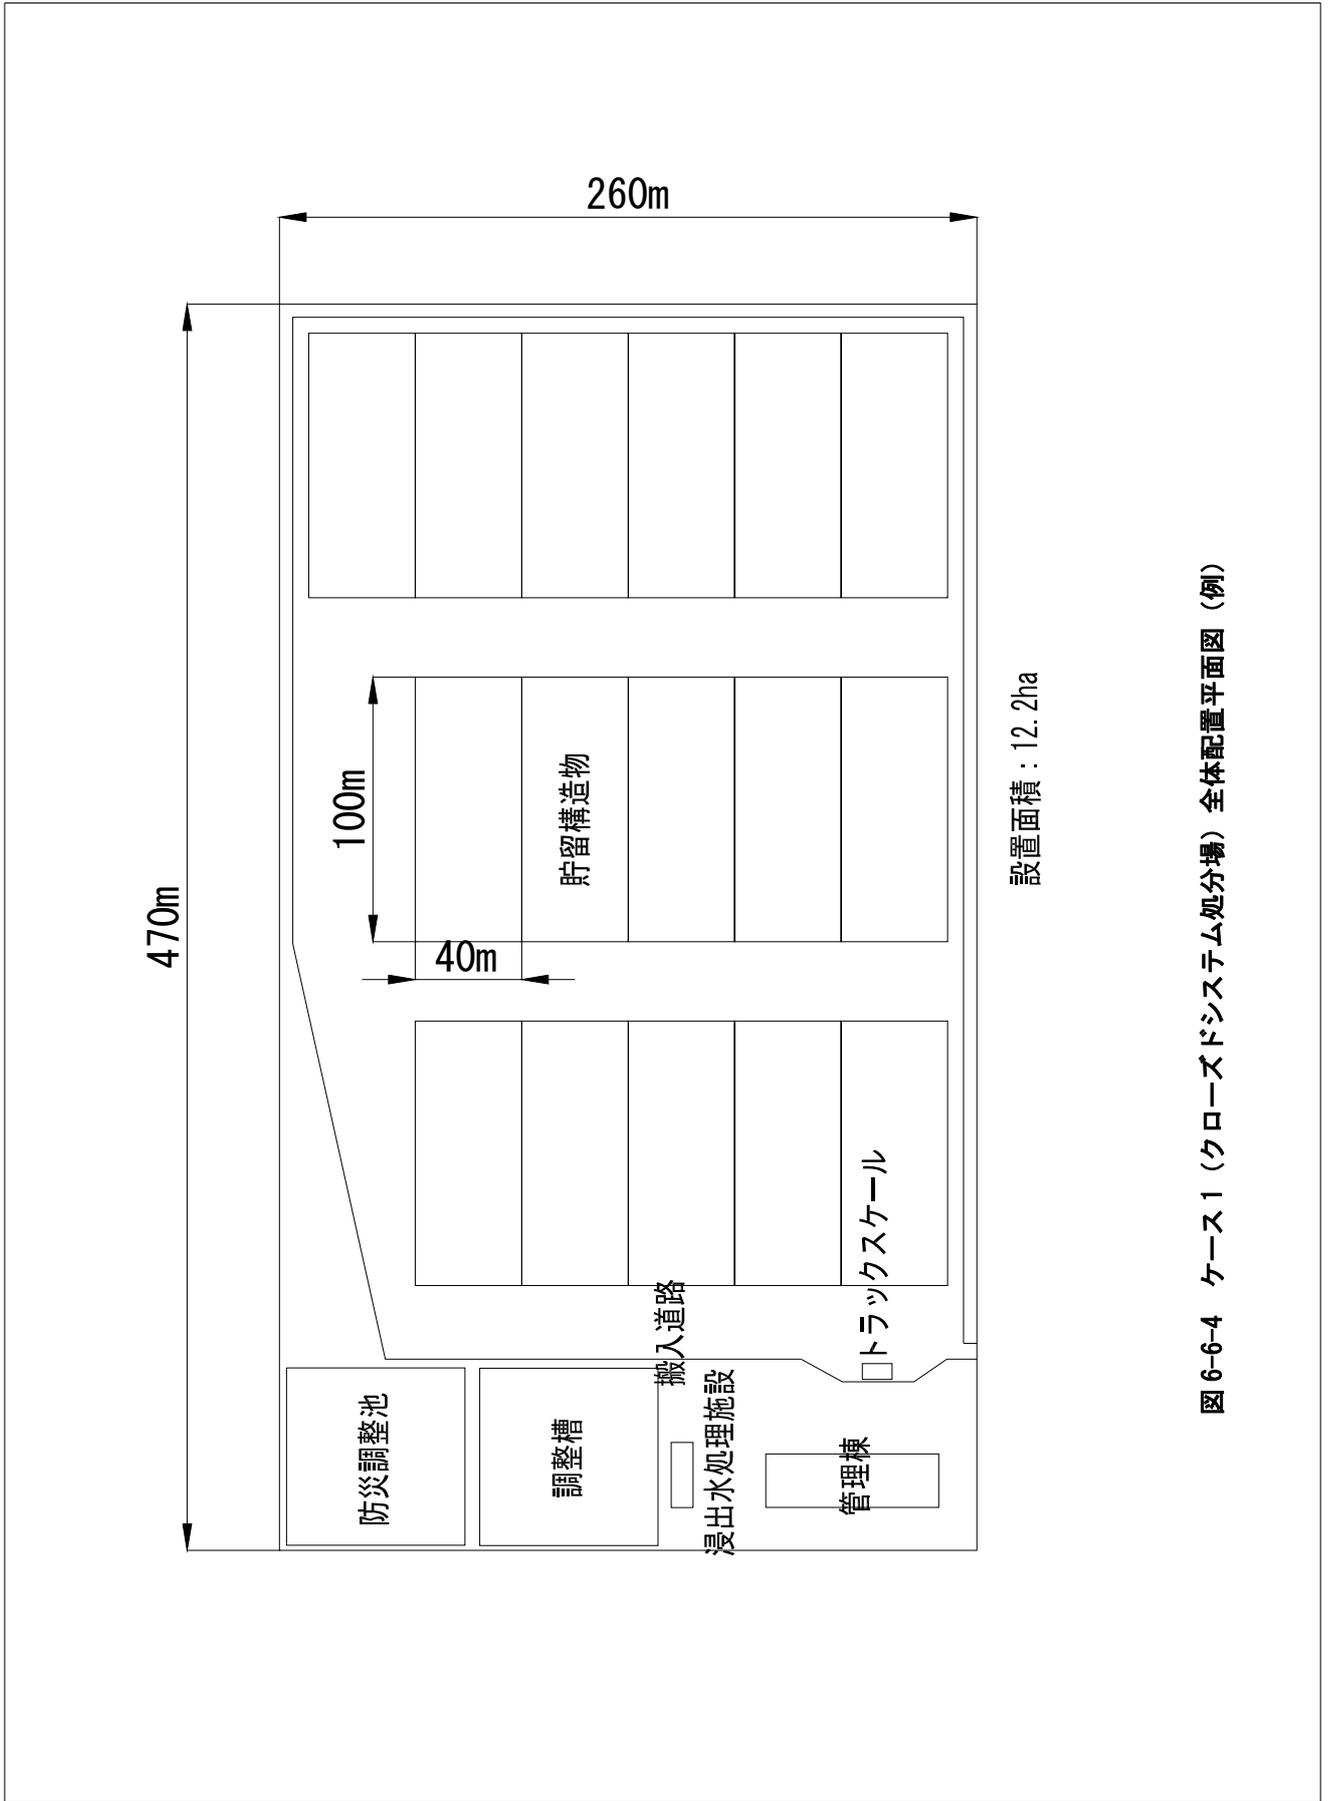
ケース 1 (クローズドシステム処分場) 全体配置平面図 (例)
